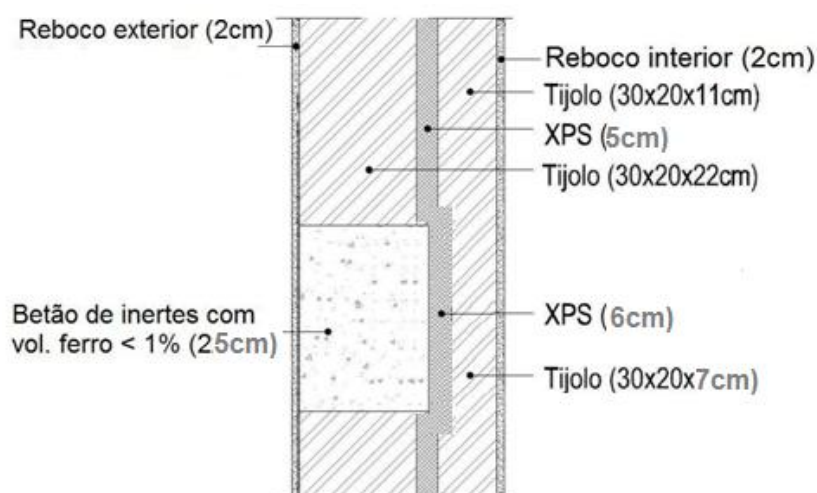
Elementos exteriores do tipo 1: parede (ParE) e pilar (PilarE).
